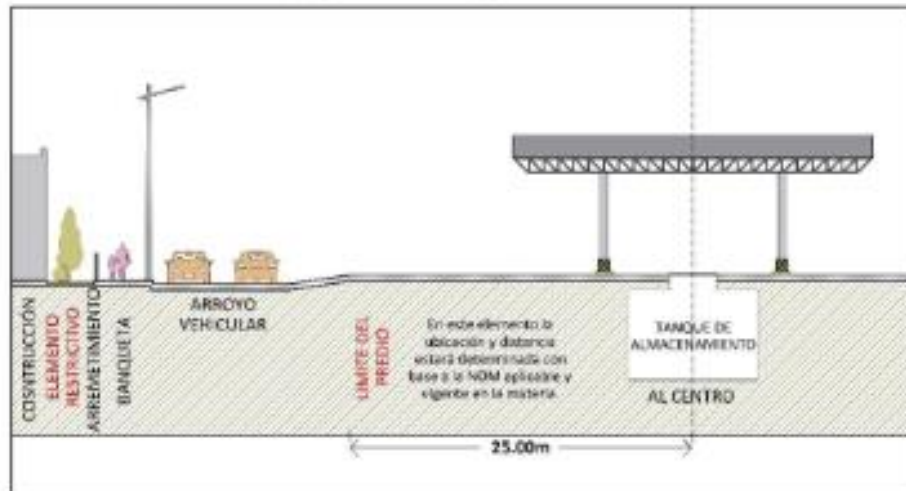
Distancias mínimas entre elementos externos y la tangente de recipientes de almacenamiento de Planta de Distribución de Gas L.P. tipo C-1, C-2, C-3 y C-4.
